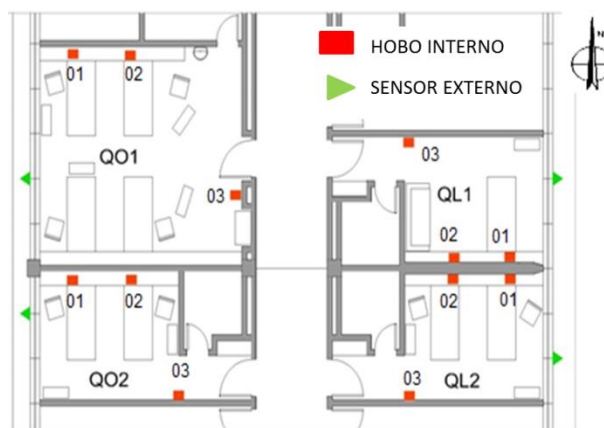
Planta baixa dos quartos com posição dos “hobos”.
